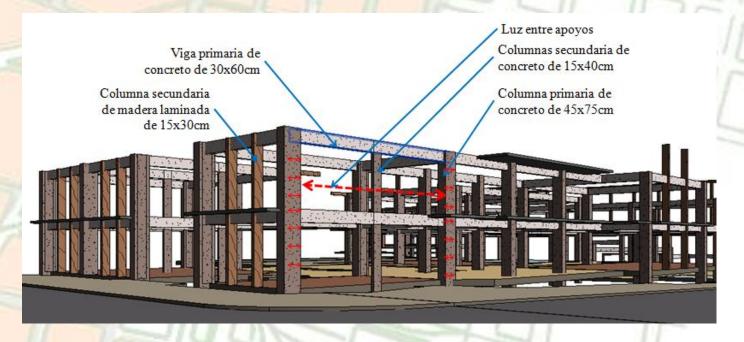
Detalle de configuración de elementos estructurales primarios y secundarios. Fuente: propia.
